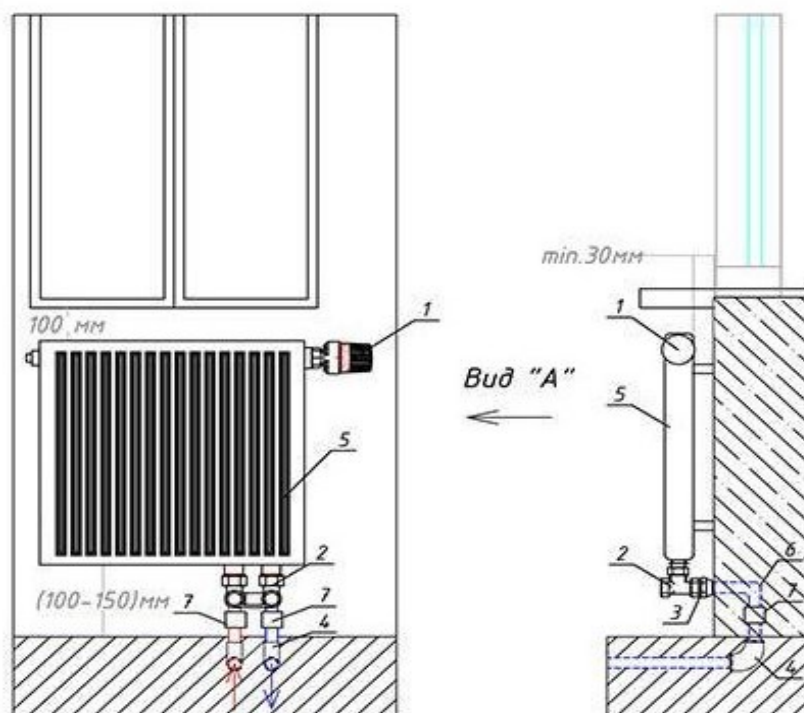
Чертеж установки прибора отопления: 1 – головка термостатическая; 2 – узел нижнего подключения; 3 – переходник; 4 – отвод 90; 5 – отопительный прибор (радиатор отопления); 6 – отвод крутоизогнутый; 7 – муфта соединительная
